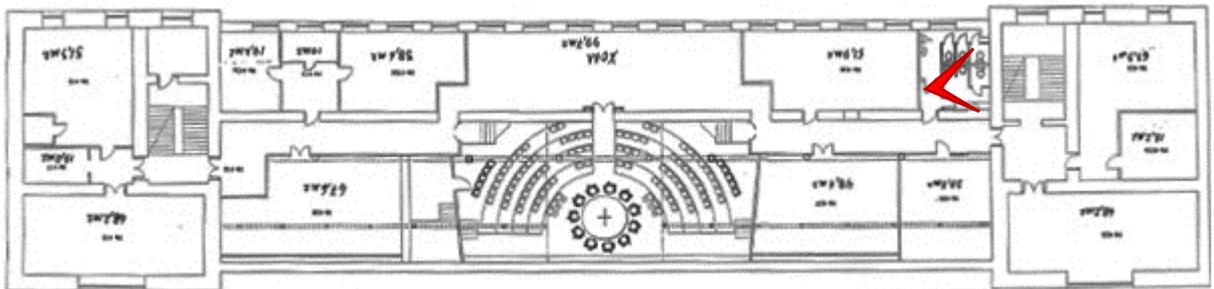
4 этаж. Помещение 10-Н(7,8).
